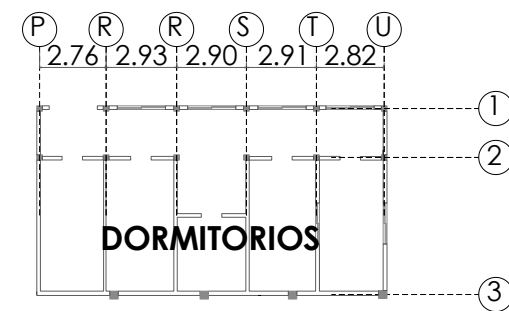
Planta Subterránea 3. Ex Academia Militar Juan Gómez Rendón
